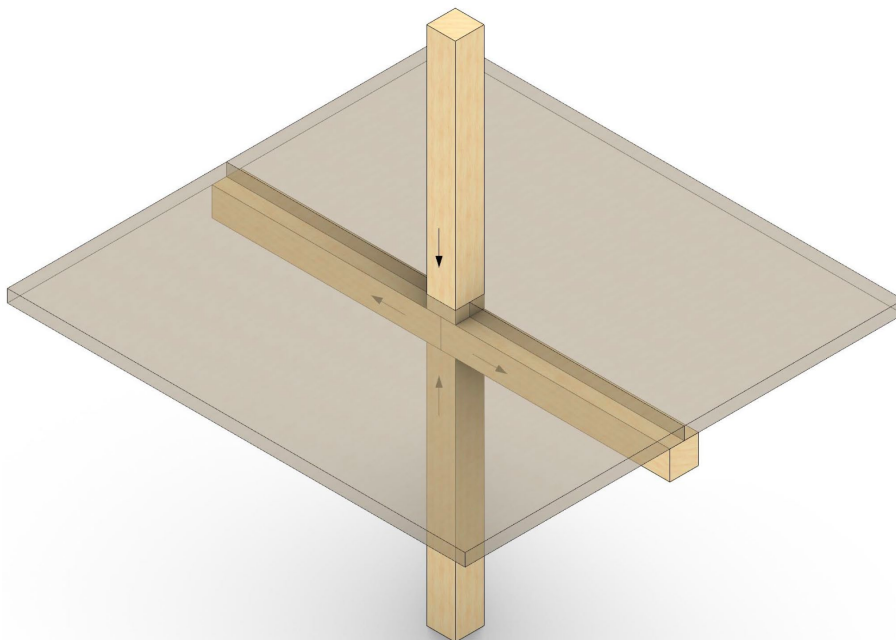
Deckenknoten in Skelettbauweise mit Hauptbeanspruchungen ©Luca Gottlob
